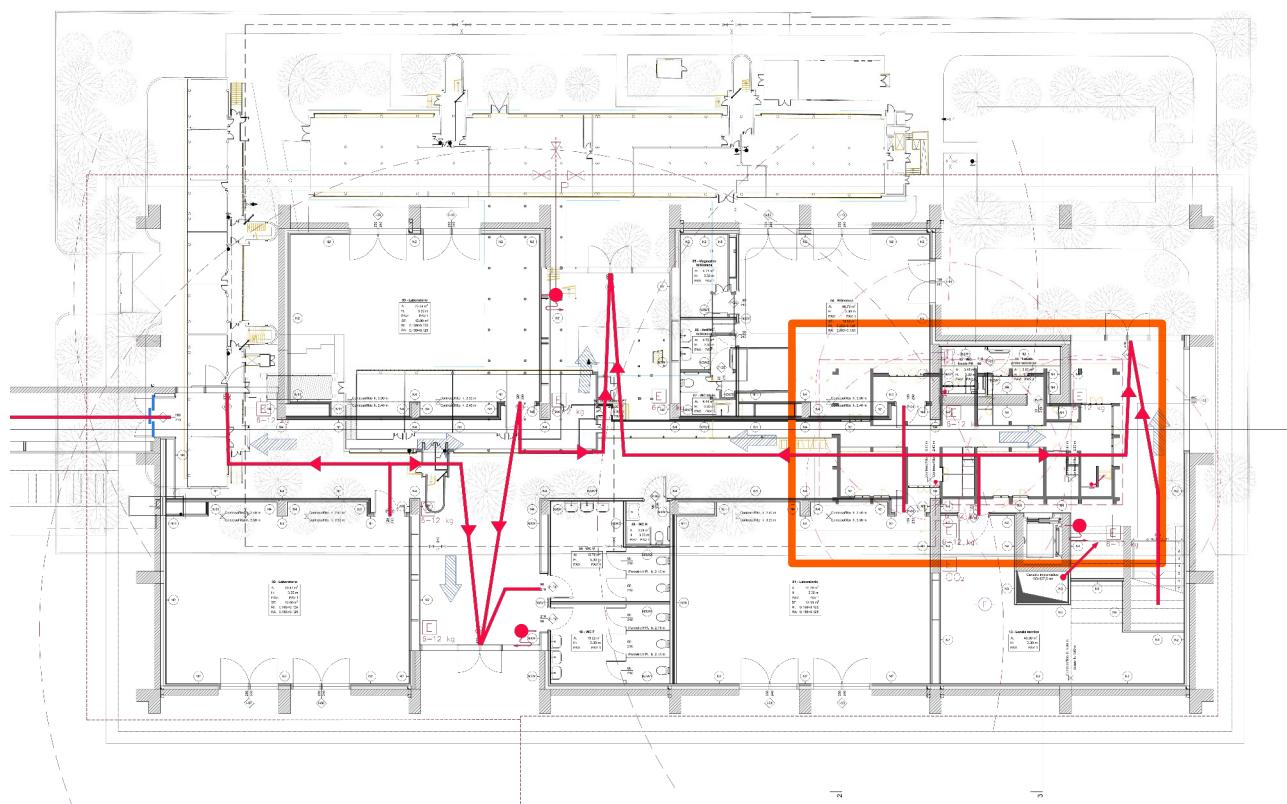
Planimetria generale del plesso scolastico con inserito il nuovo edificio
